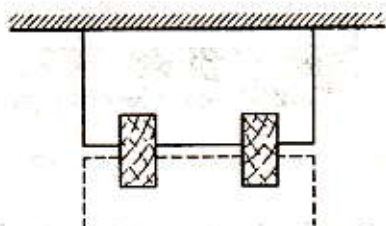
Отверстия в фундаменте храма для установки деревянных прокладок
